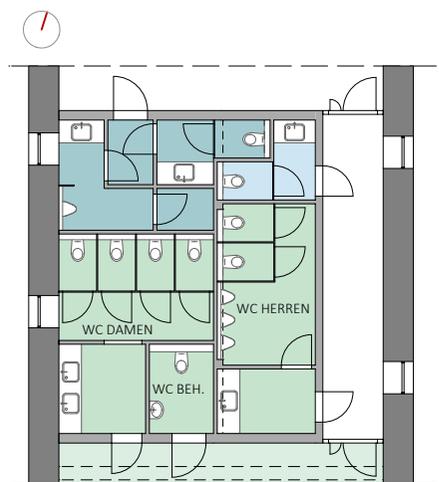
Erdgeschoss Restaurant Nasszellen, M 1:200
